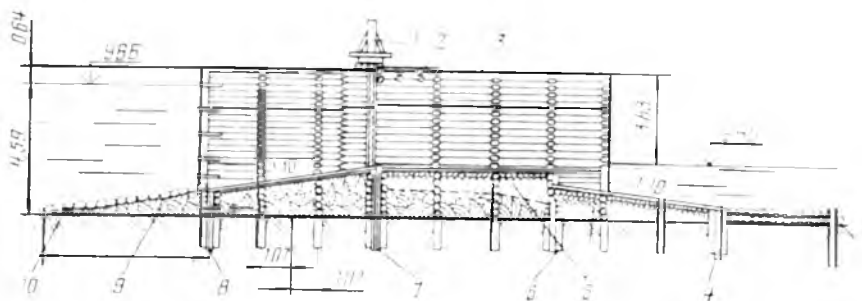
Продольный разрез по ряжевой плотине со свайно-ряжевым флютбетом:
